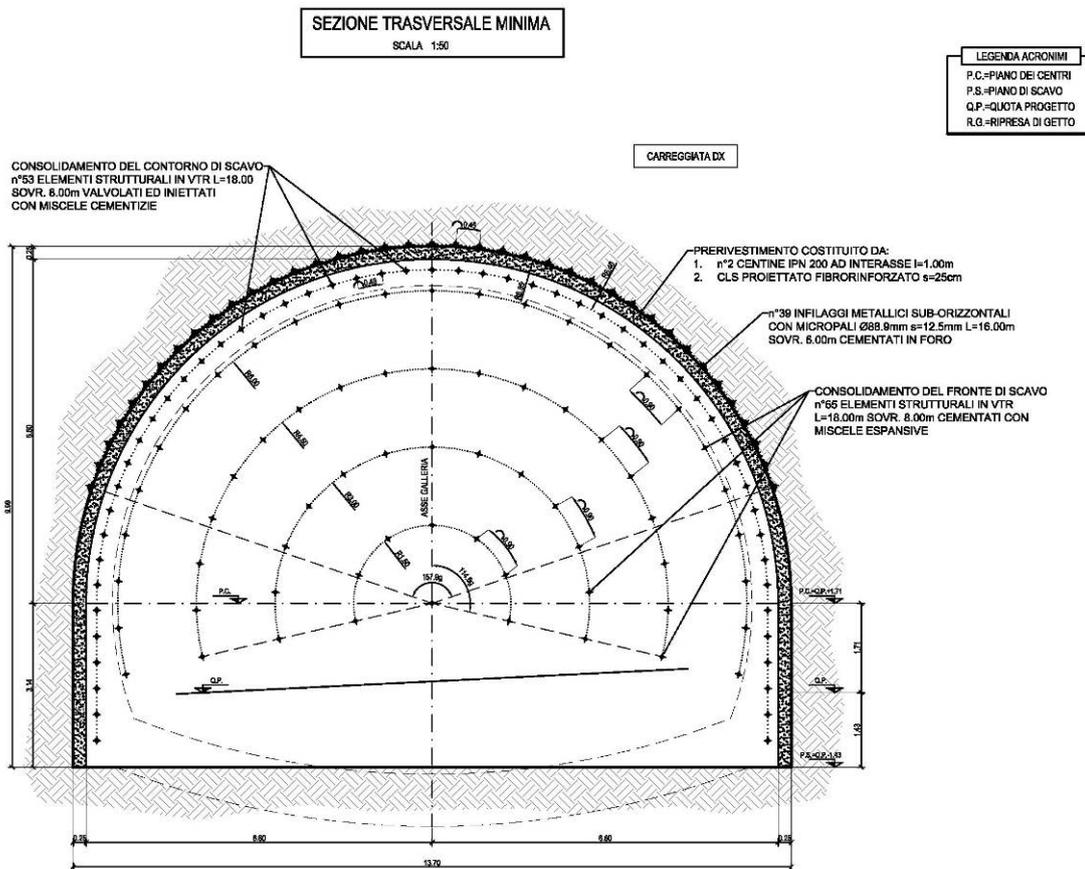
Sezione trasversale (minima) della sezione tipo C2v.
